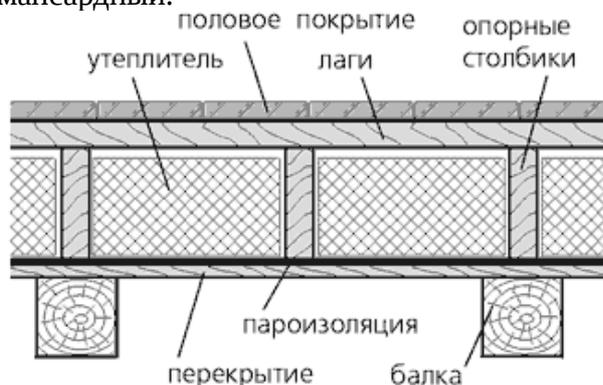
Конструкция перекрытия второго этажа с утеплителем.
